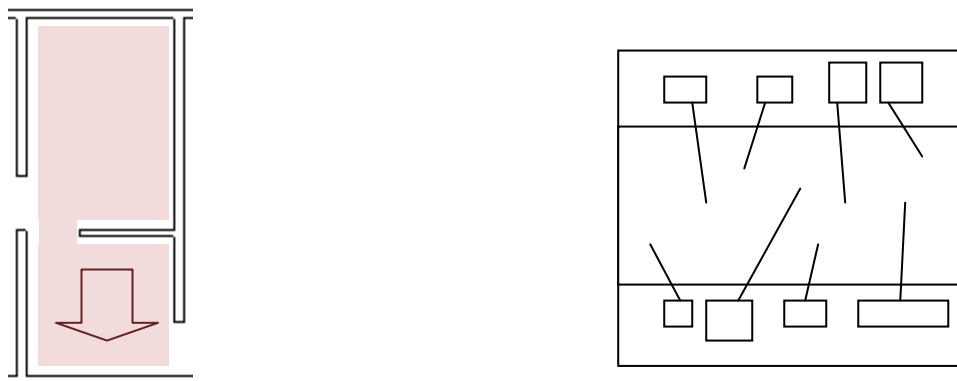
Módulo Edificações. Planta baixa e elevação esquemática da parede 06.
